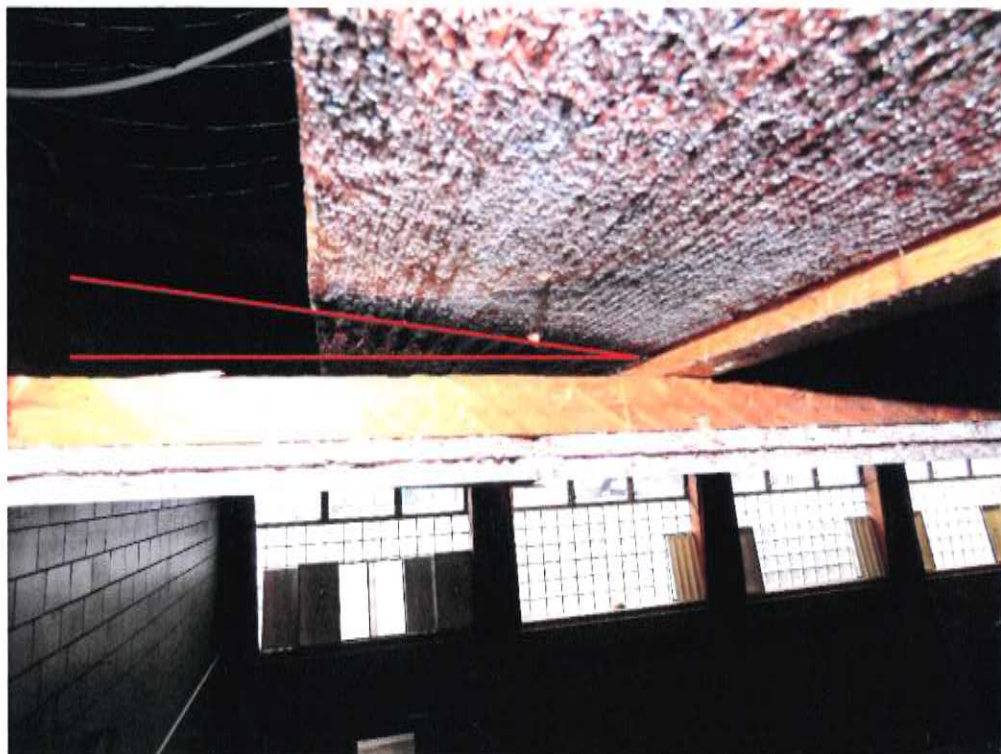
Holz-Wellstegträger: am Untergurt erkennbare Schiefstellung des Trägers
